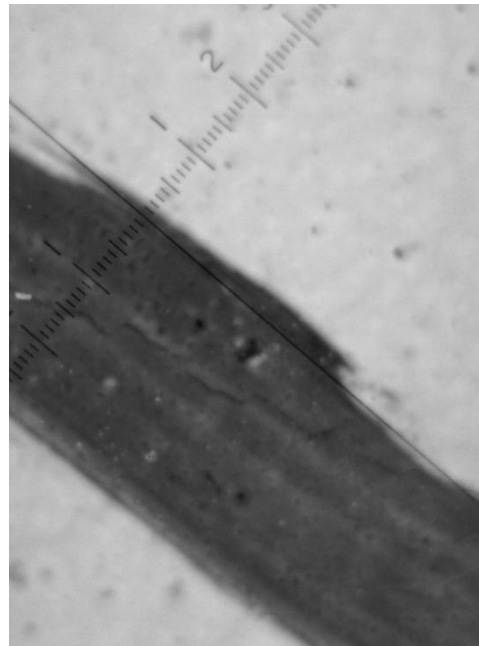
fisura vista con lupa 7x 0,1 mm
